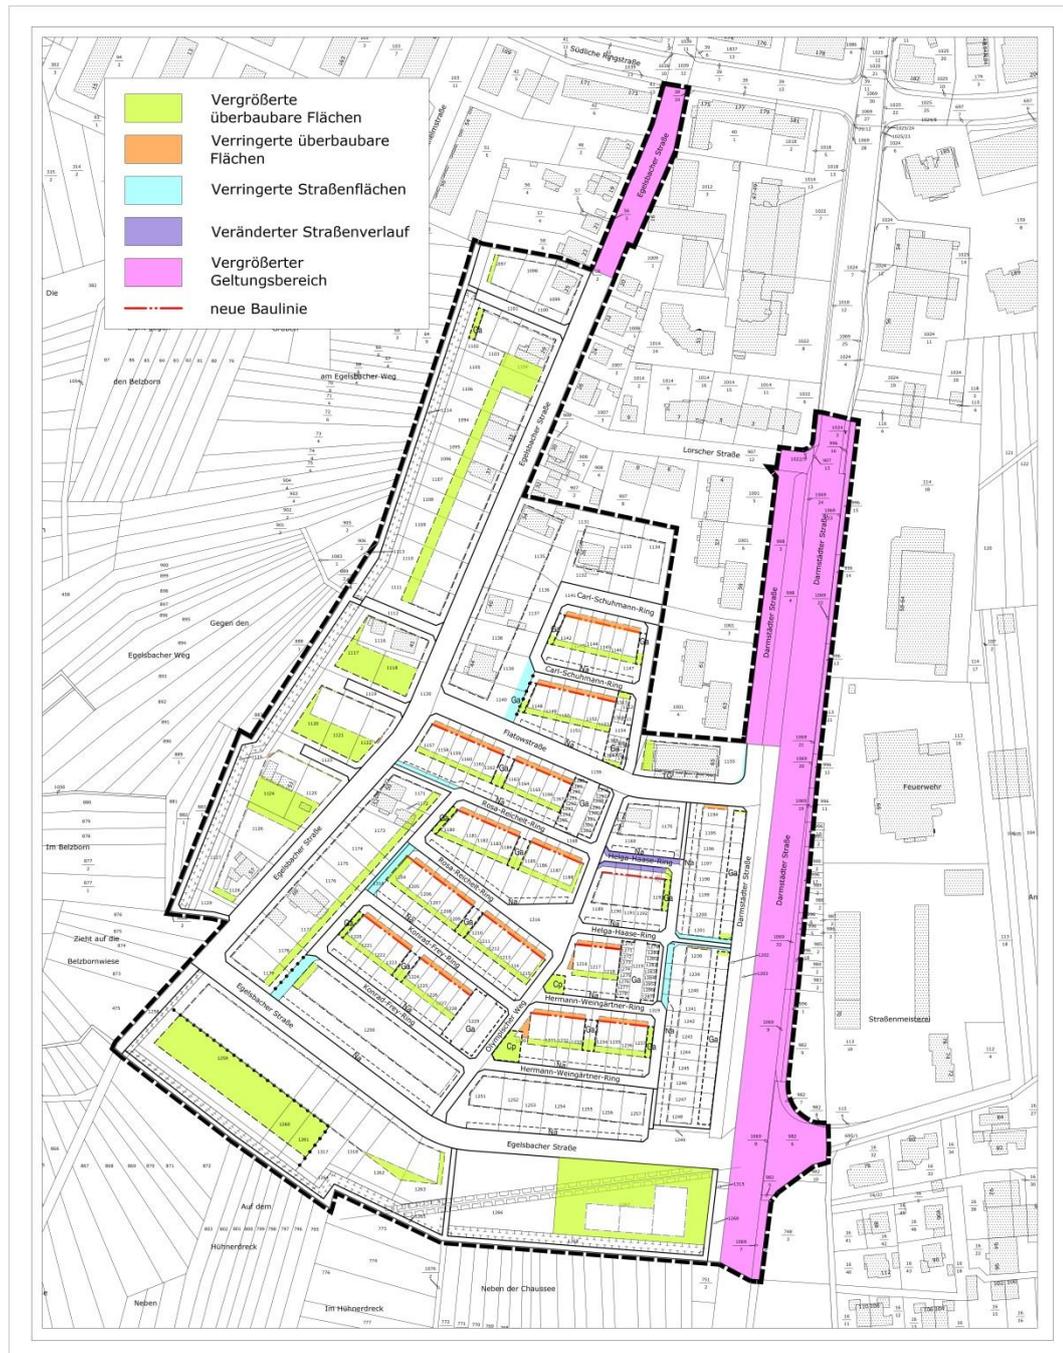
Bildhafte Zusammenfassung der Änderungen Bebauungsplan Nr. 13 A, 1. Änderung mit Bebauungsplan Nr. 13.A.2
